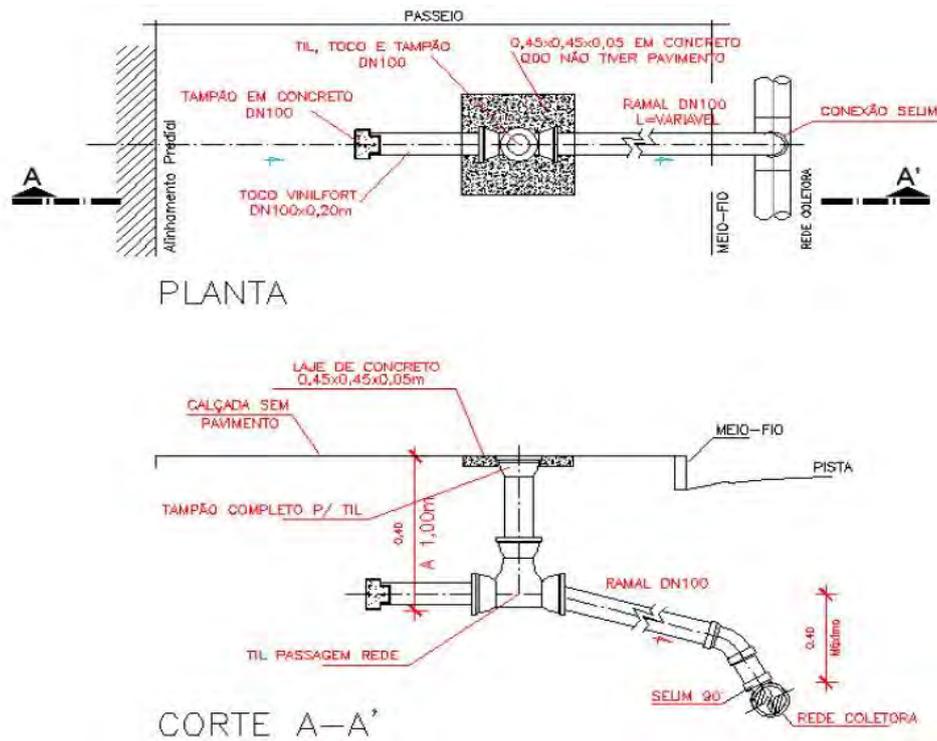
Padrão SANESUL de Ligação Domiciliar de Esgoto – Planta e Corte.
